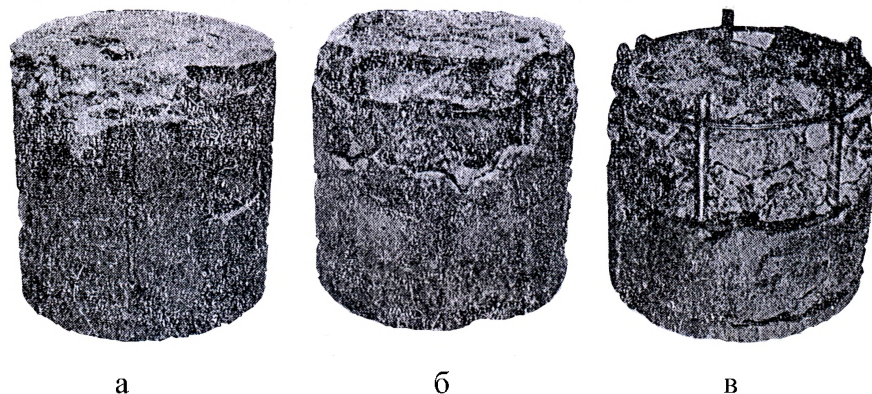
Армований бетонний зразок у різних фазах руйнування.
